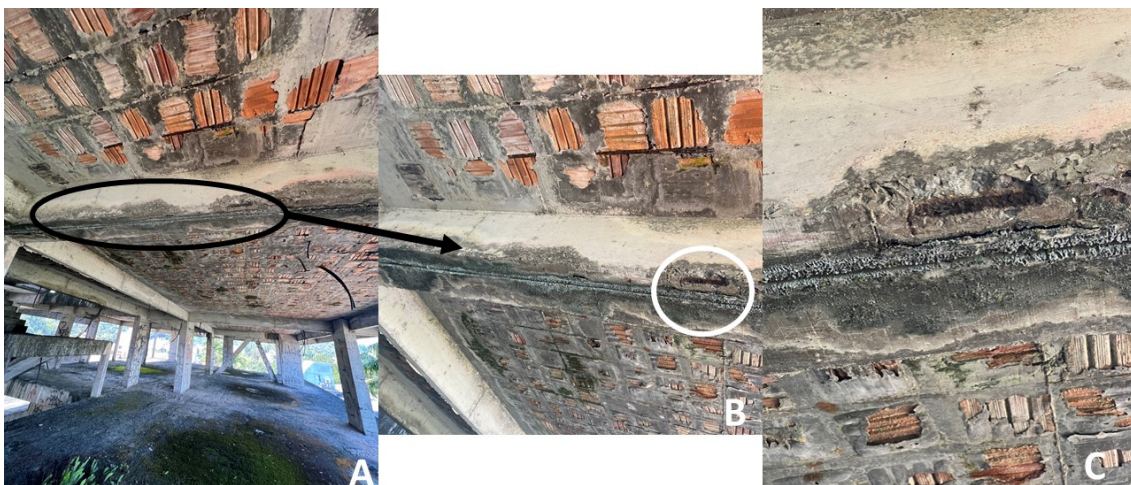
Viga J1: (A,B) localização; (C) pormenor.
